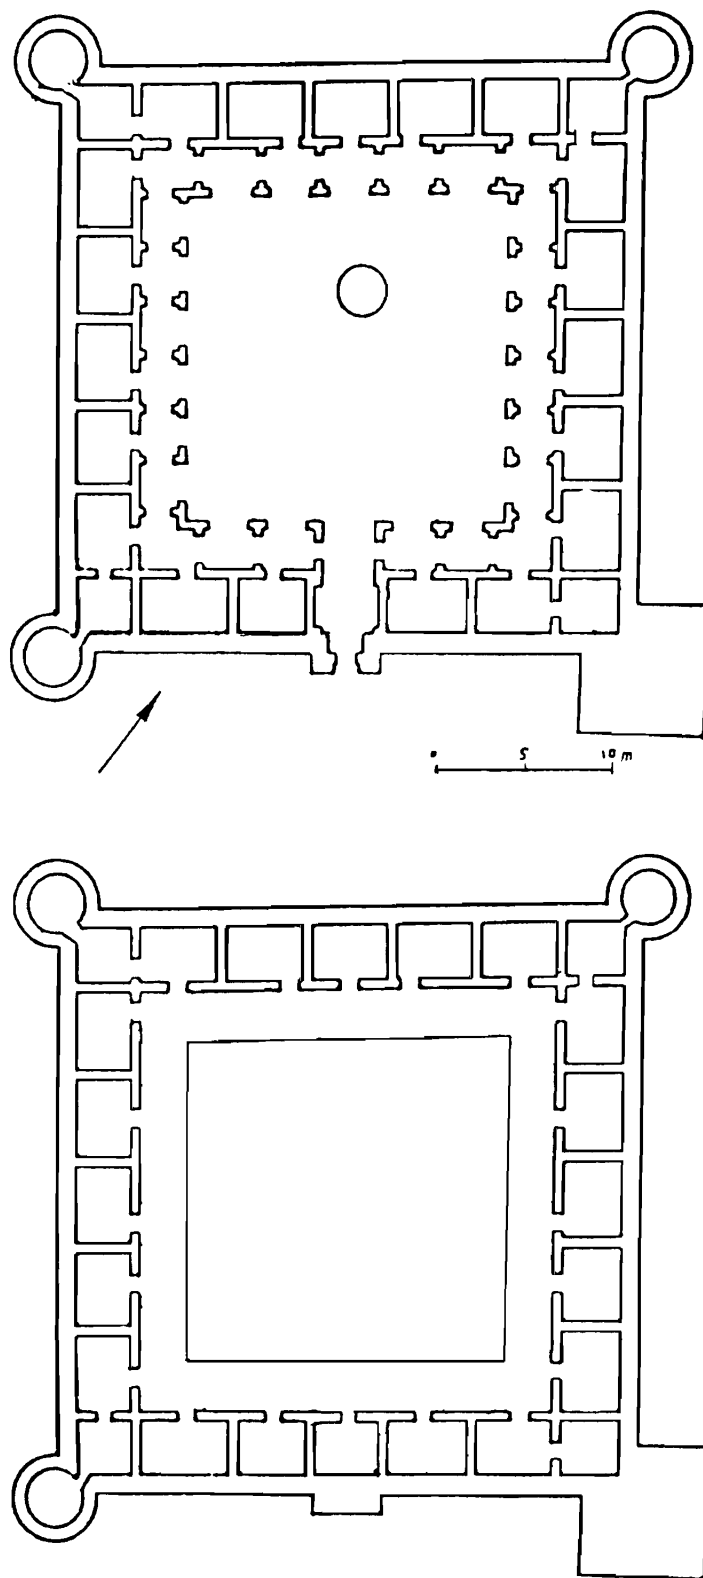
Planta del Qasr al-Kabir de Monastir. Reconstrucción hipotética de su estado original: A. Planta baja, B. Planta alta.
